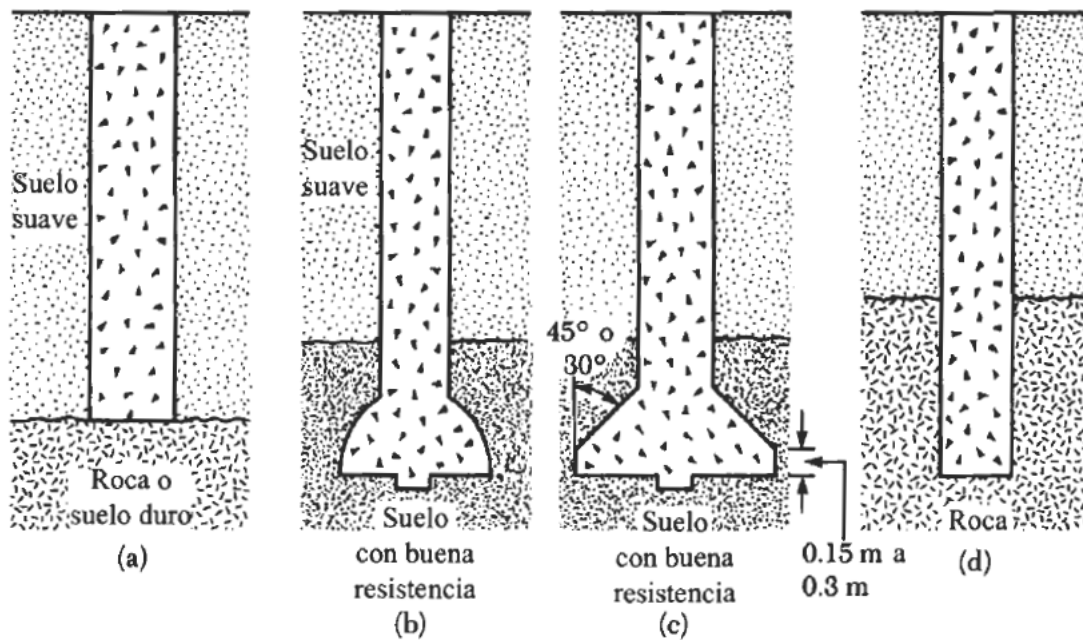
Tipos de pilas perforadas: (a) Pila recta; (b) y (c) pilas con campana; (d) pilas rectas empotradas en roca.
